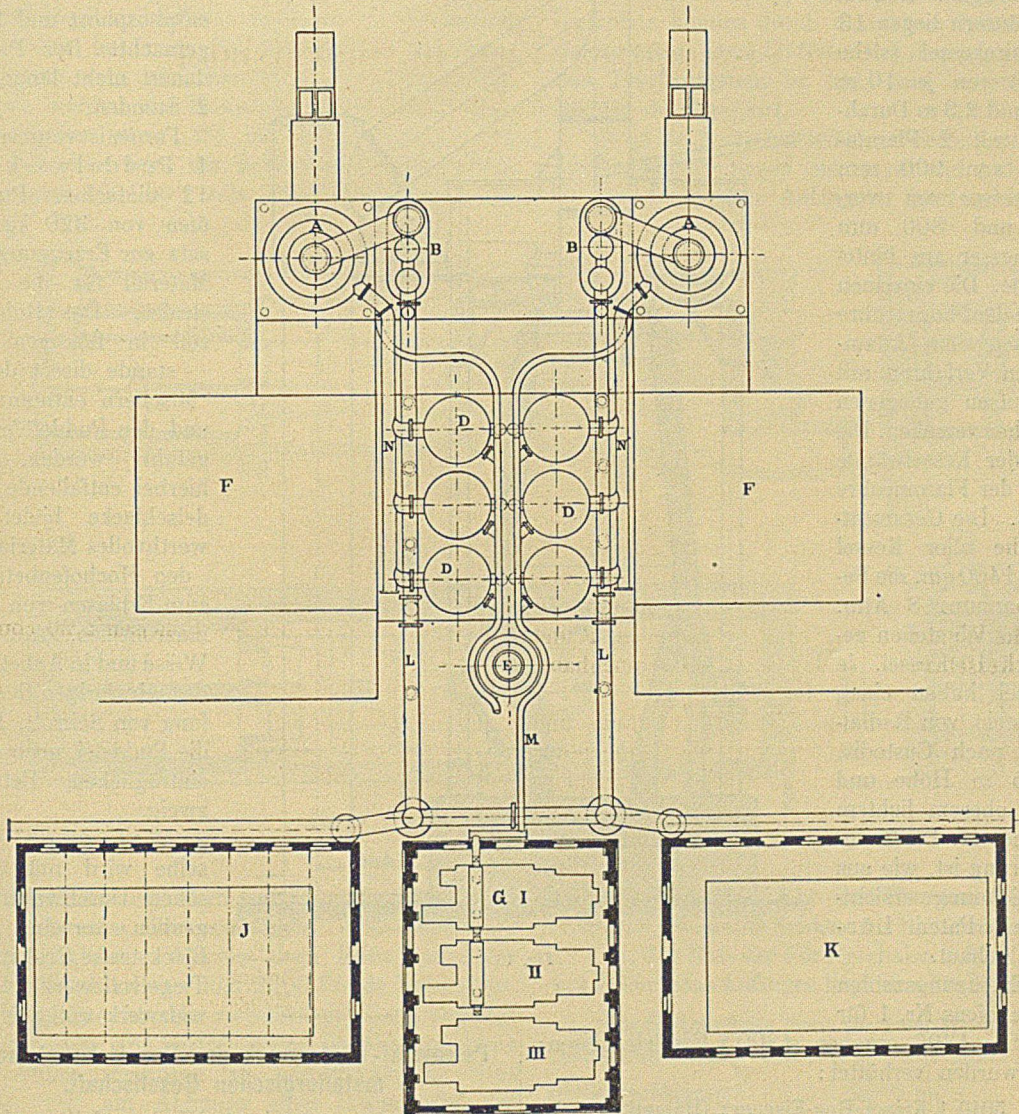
Lageplan der Donezko-Jurjewski-Hütte.
